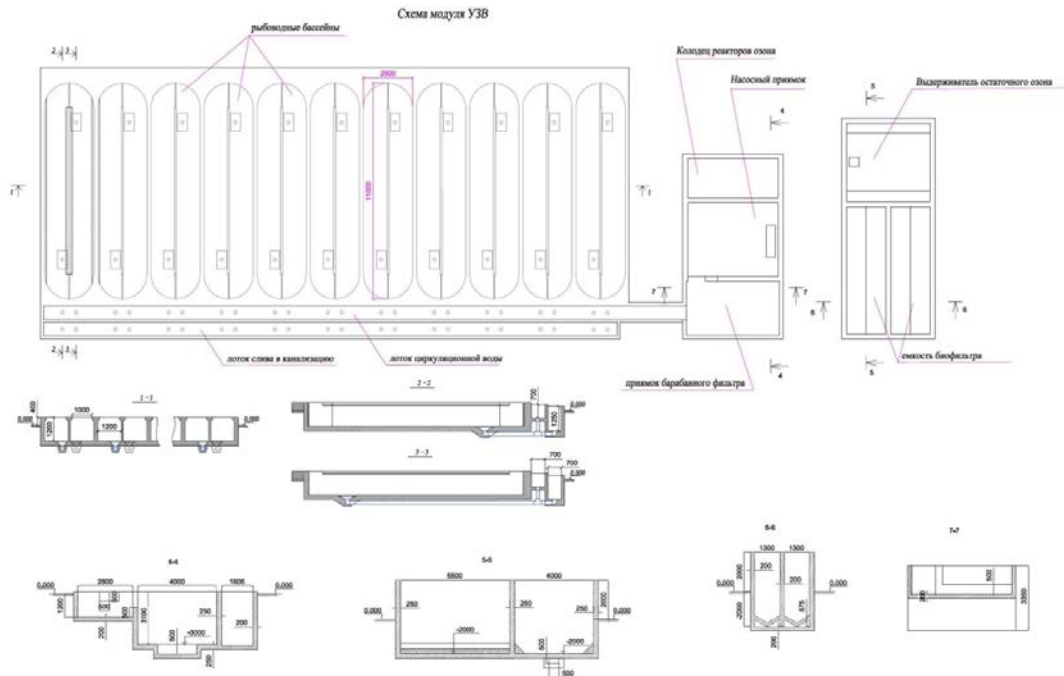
Схема модуля УЗВ с бетонными бассейнами овальной формы
